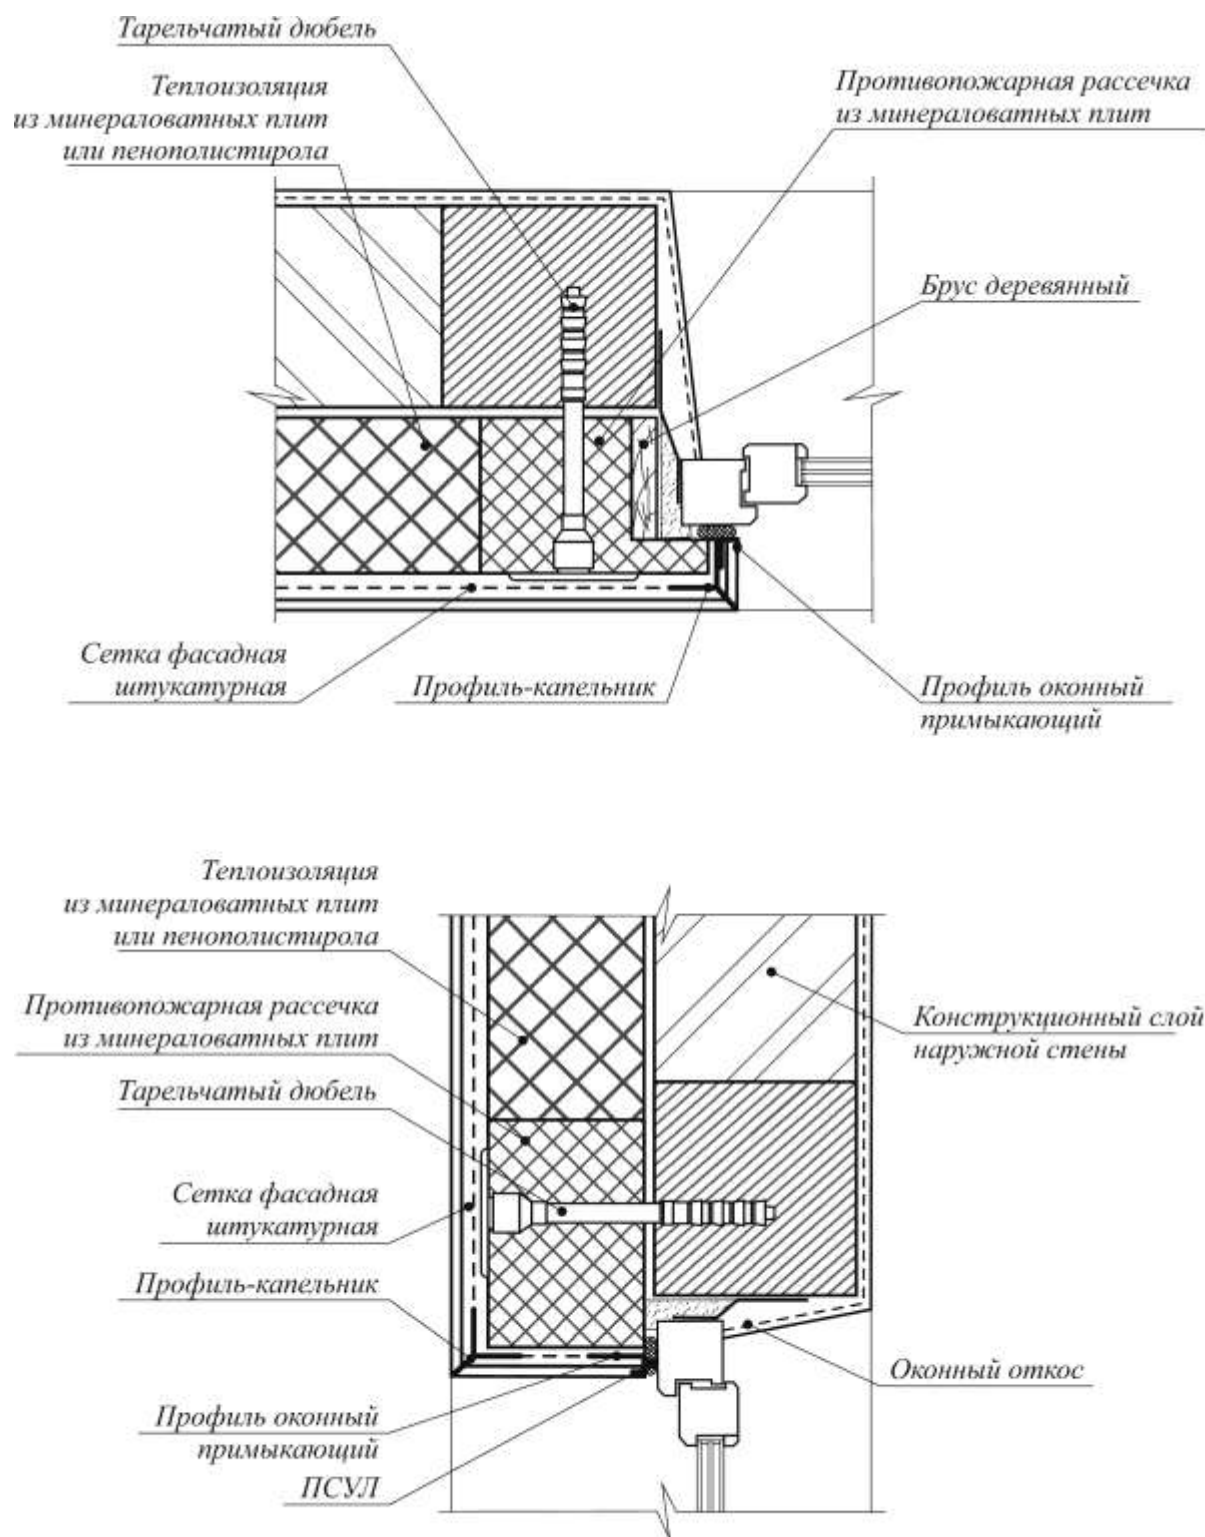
Узлы примыкания наружной стены с тонким штукатурным слоем к оконным проемам
